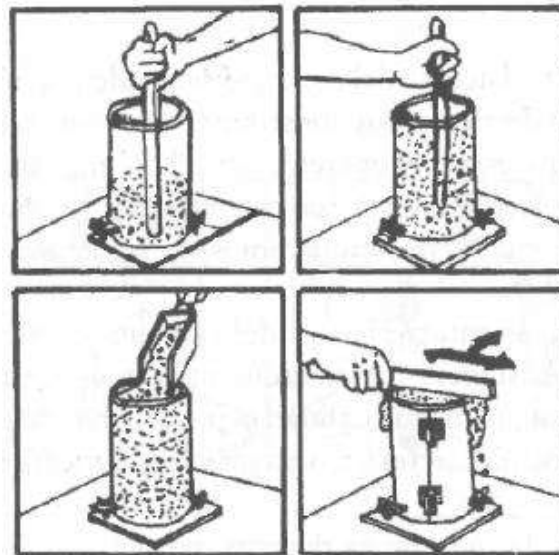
IMAGEN II – TOMA DE CILINDROS DE CONCRETO – (CONCRETO Y OTROS MATERIALES PARA LA CONSTRUCCION)
